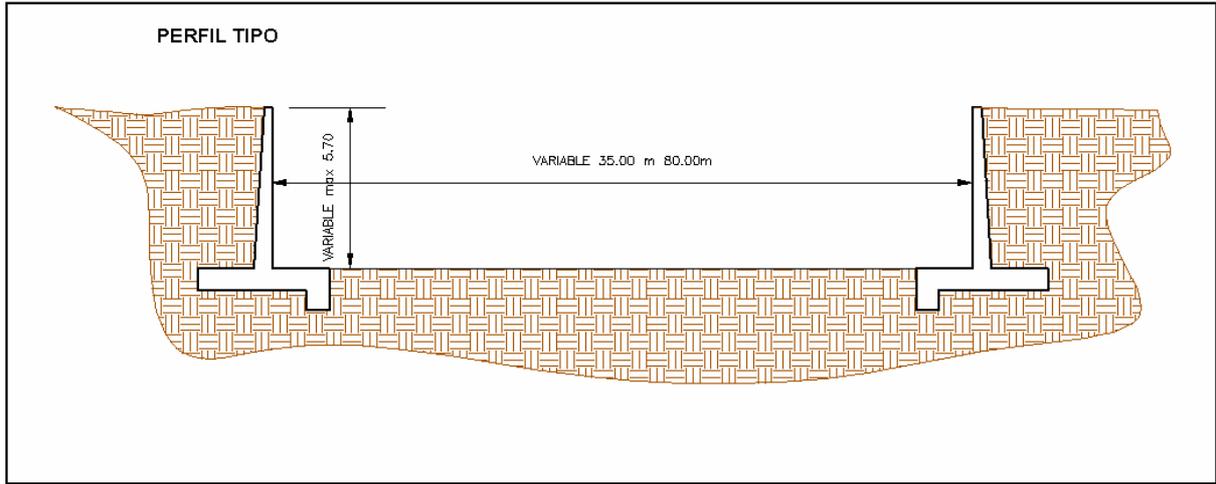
Perfil Transversal Tipo de la Estructura de Descarga.
